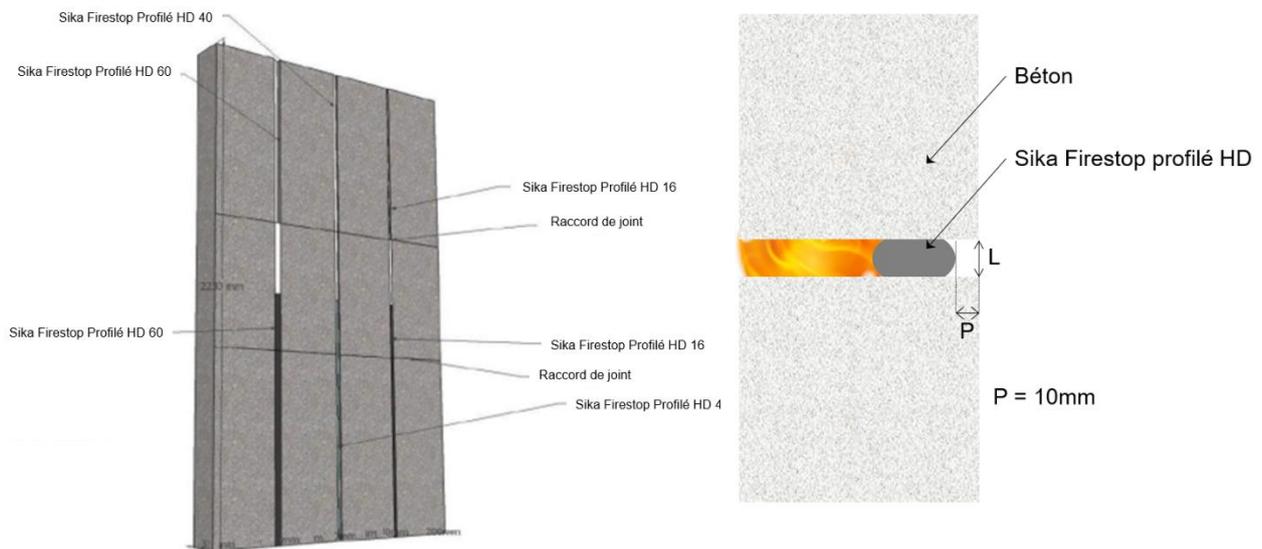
Mise en œuvre des joints linéaires coupe-feu Sika Firestop Profilé HD dans les éléments de construction verticaux
